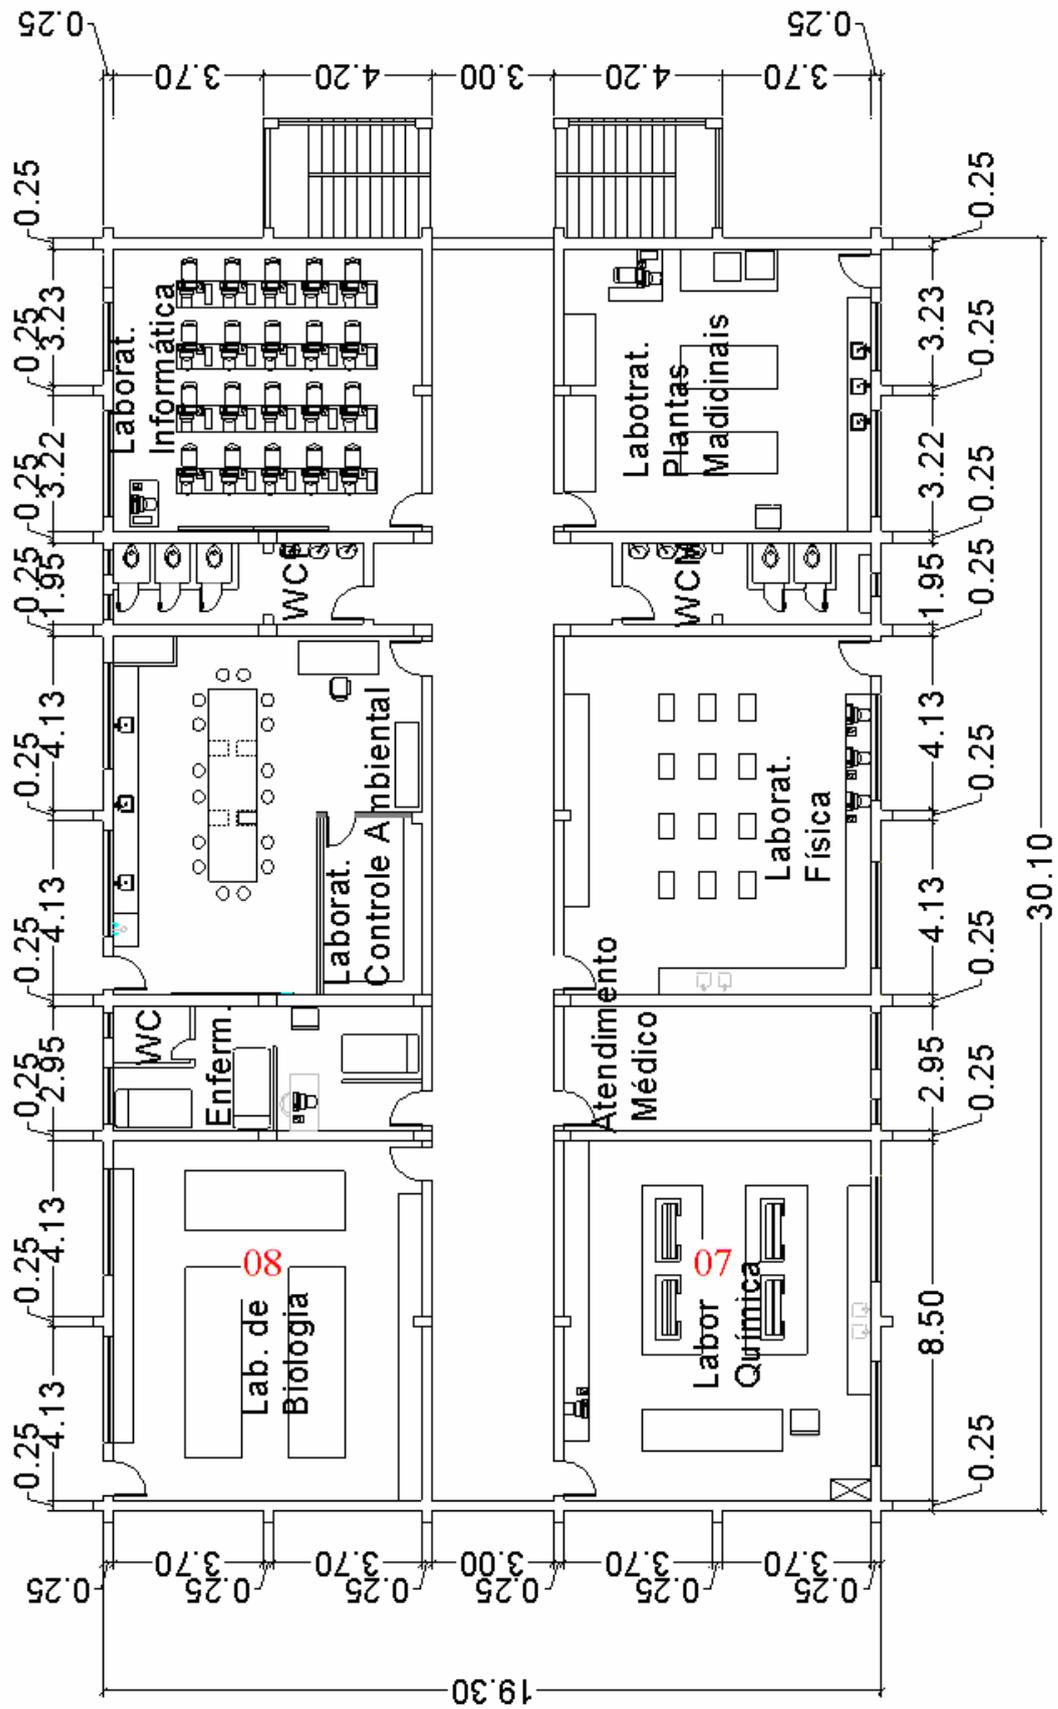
Planta baixa do pavimento térreo do bloco de laboratórios
